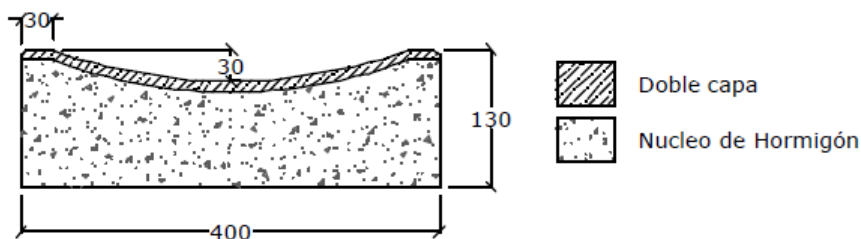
Dimensiones de la canaleta de hormigón prefabricada
